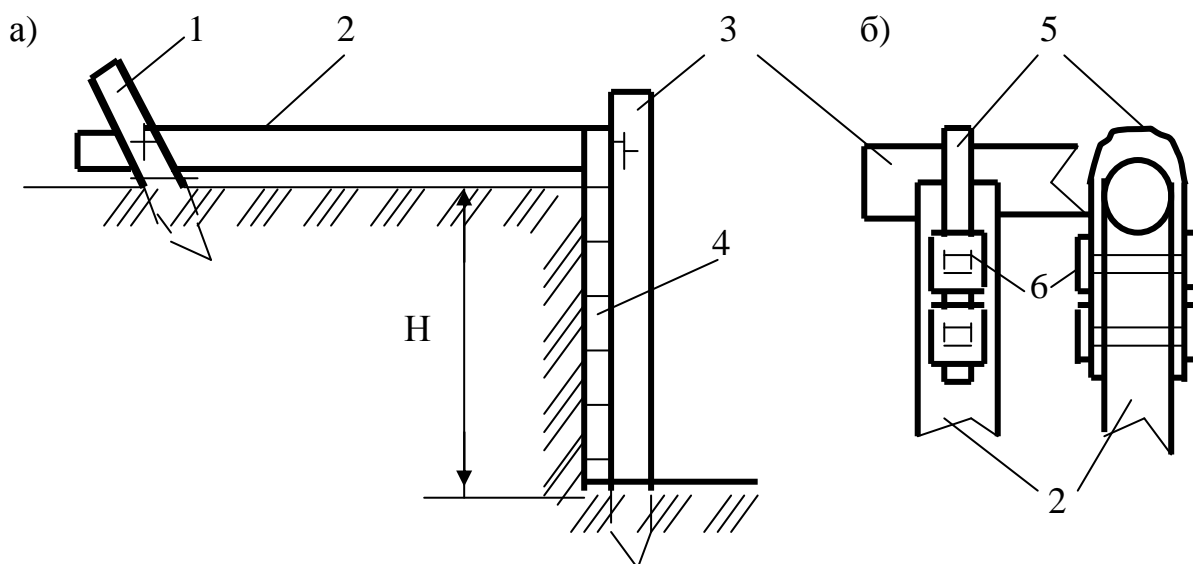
Улаштування анкерного кріплення котлованів і траншей:
